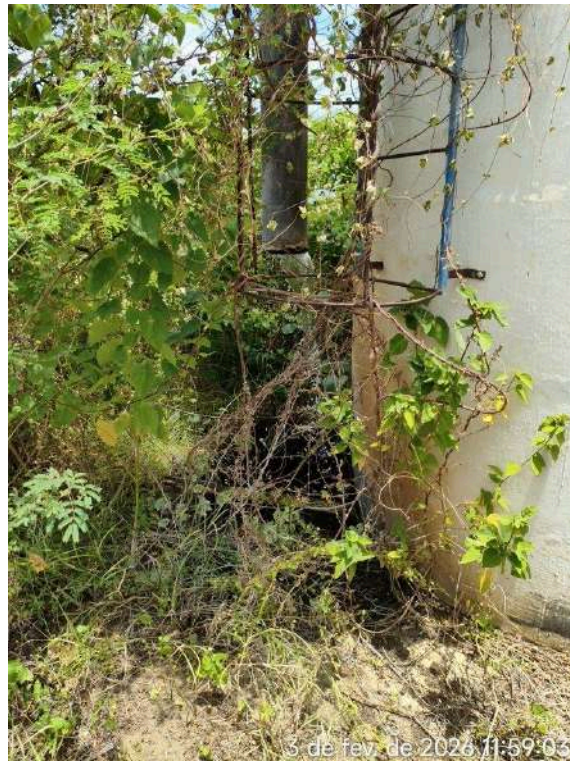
Torre de Equilíbrio (TE-02): vazamento e/ou transbordamento.
